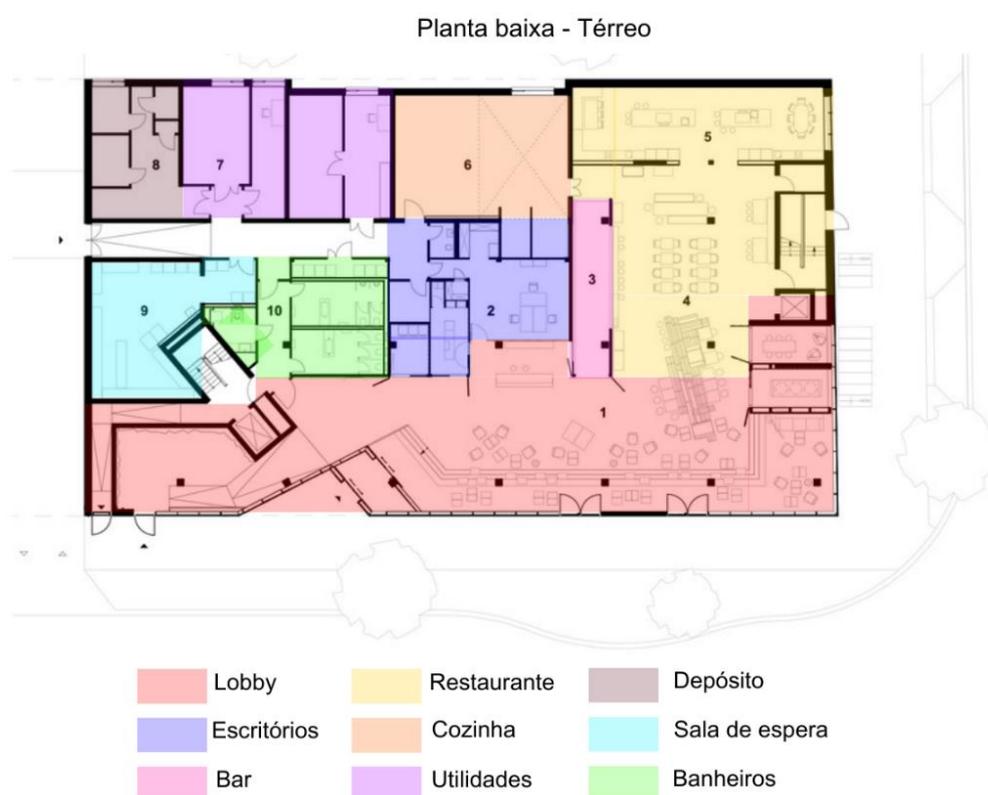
Setorização / Planta baixa térreo. Alterado pelo autor.
